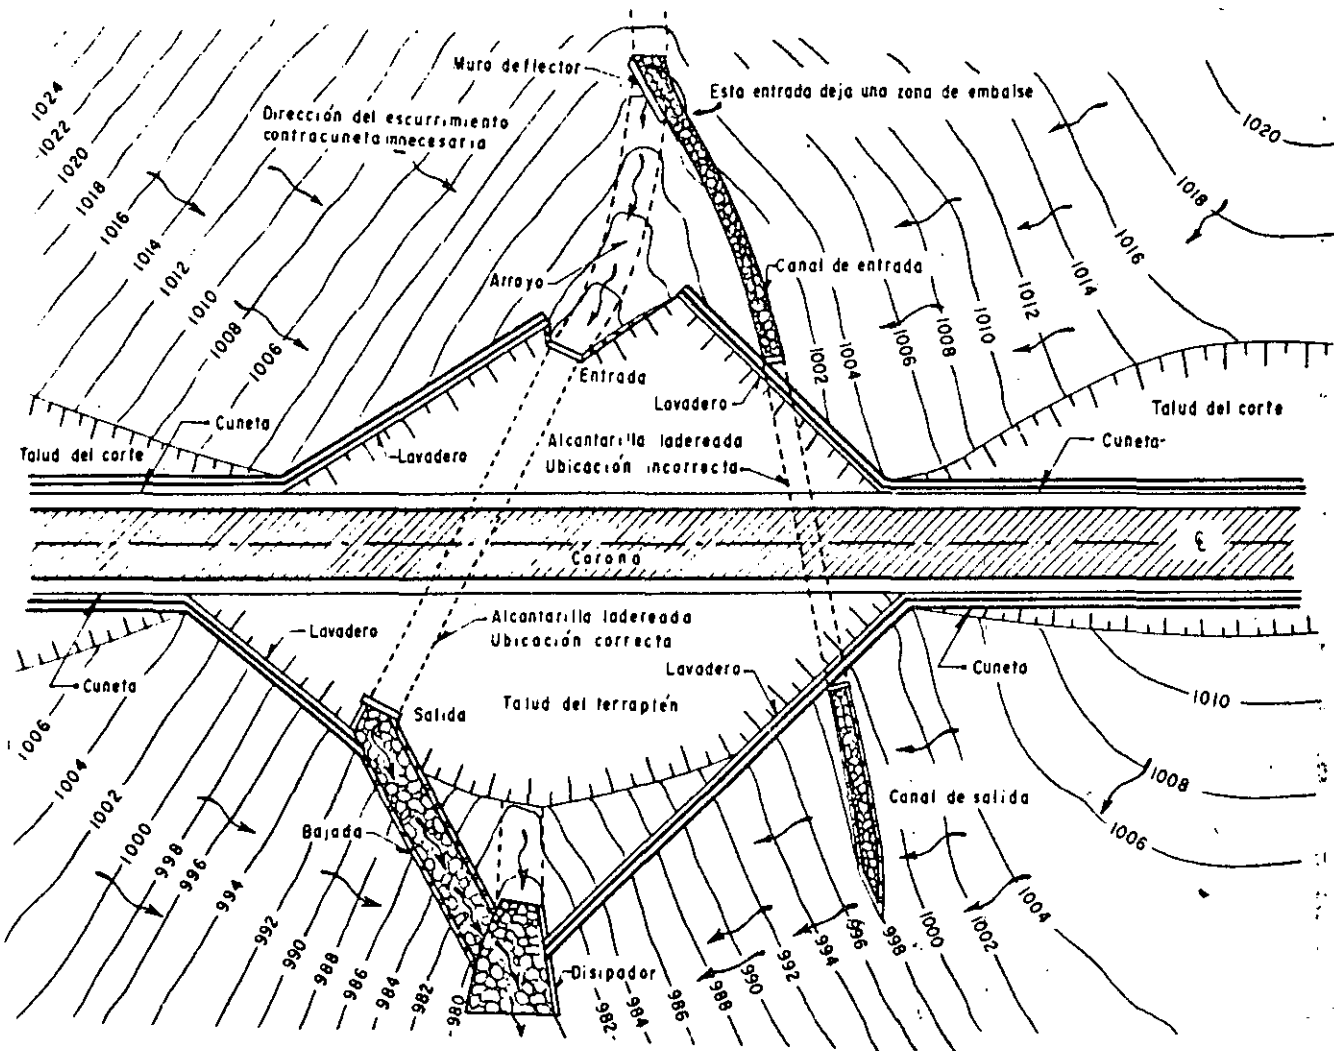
Ubicación de alcantarillas en laderas de cañadas.
